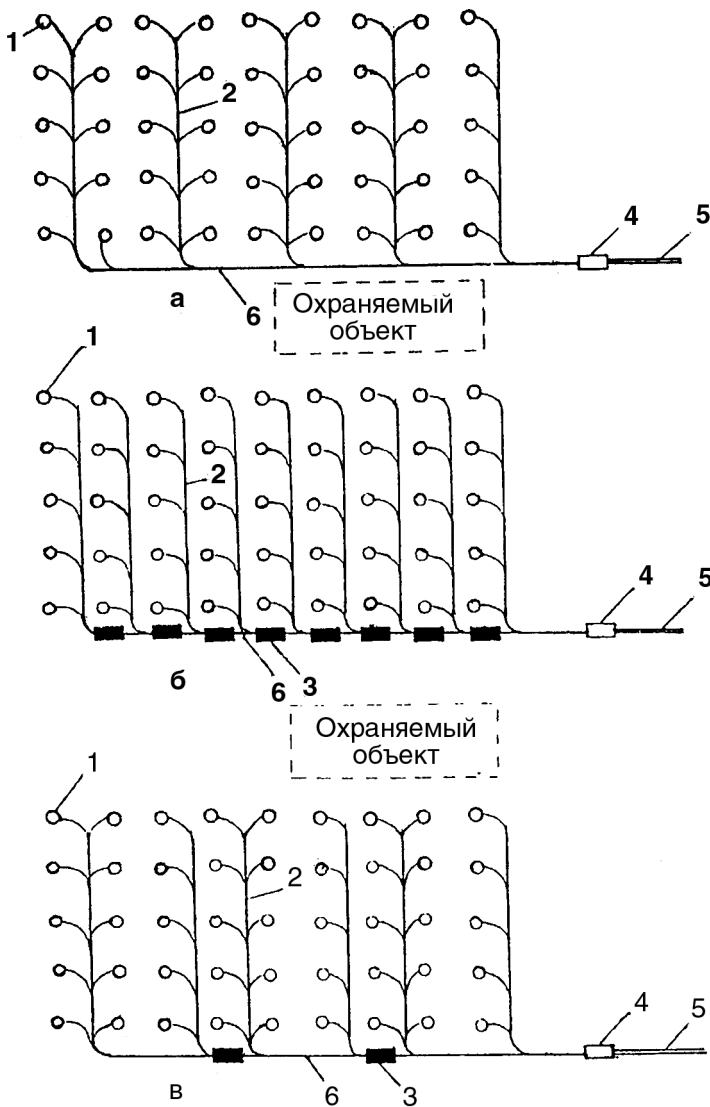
Схема монтажа взрывной сети при взрывании фундаментов;
